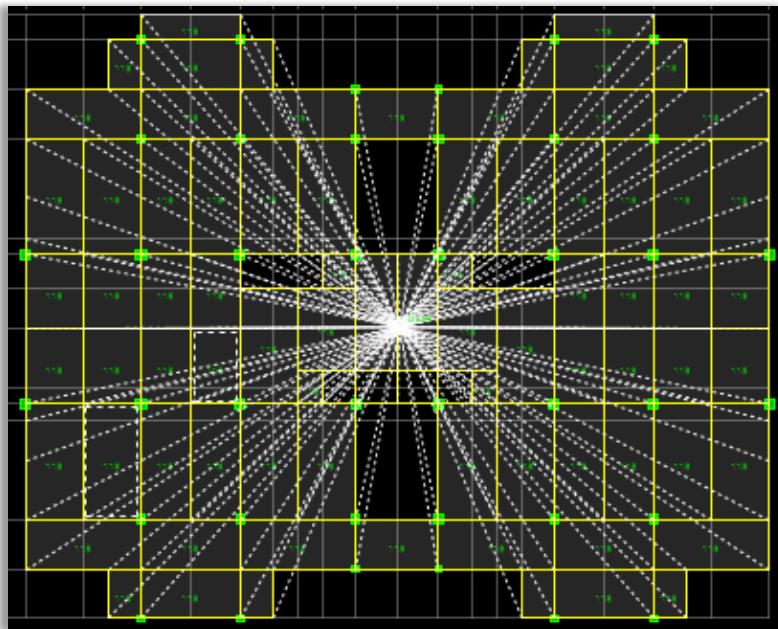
Parameter *Load Case* Beban Gempa
